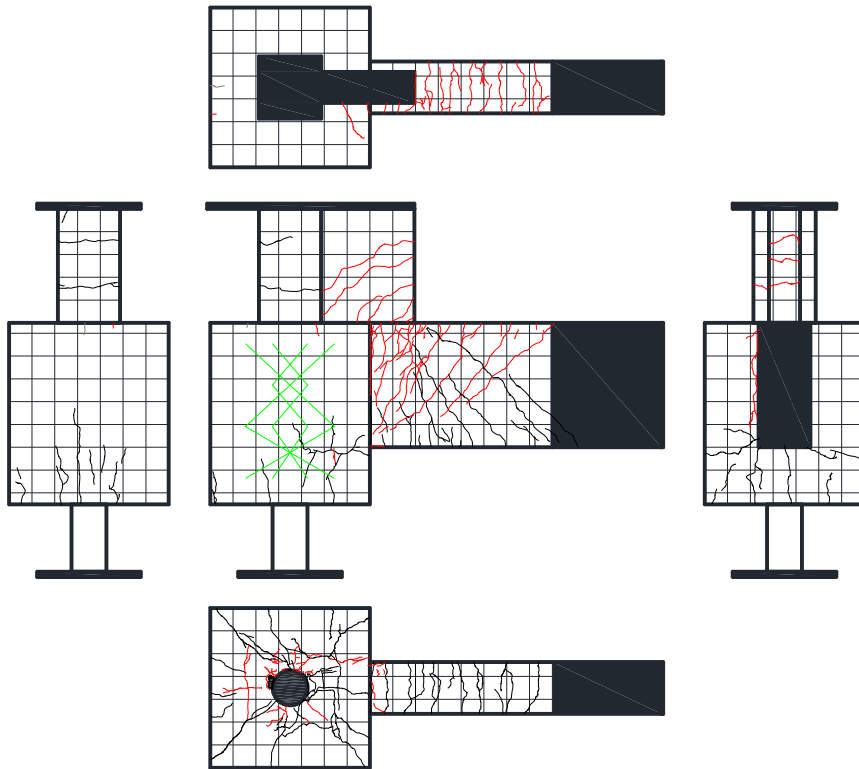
2. 3-27 試験体 DR-2 ひび割れ状況 (7Cycle)
